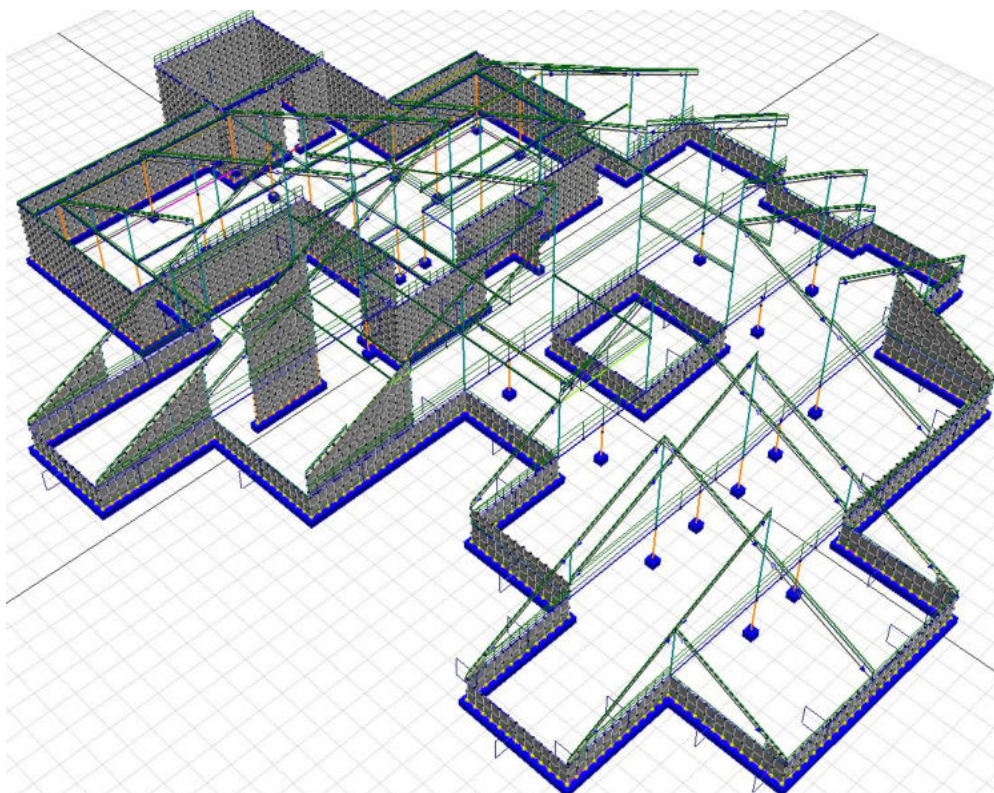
Vista wireframe con individuazione dei vincoli, dei piani rigidi e dei carichi applicati
